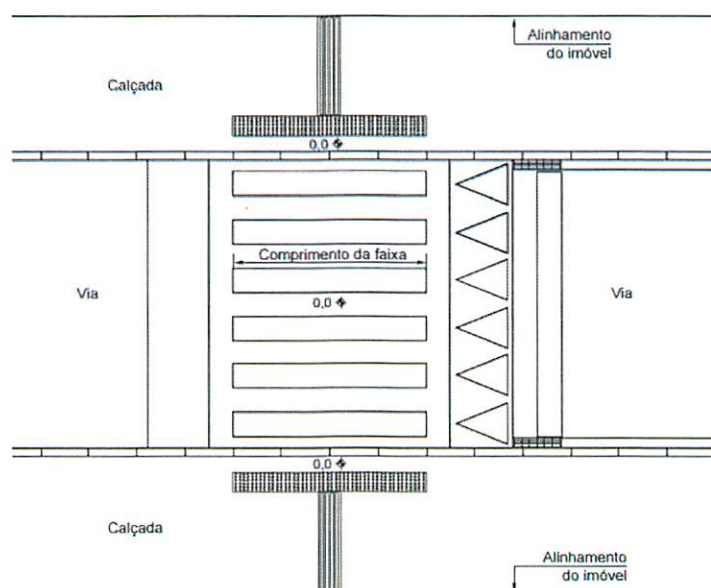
Faixa elevada para travessia – Exemplo – Vista superior
